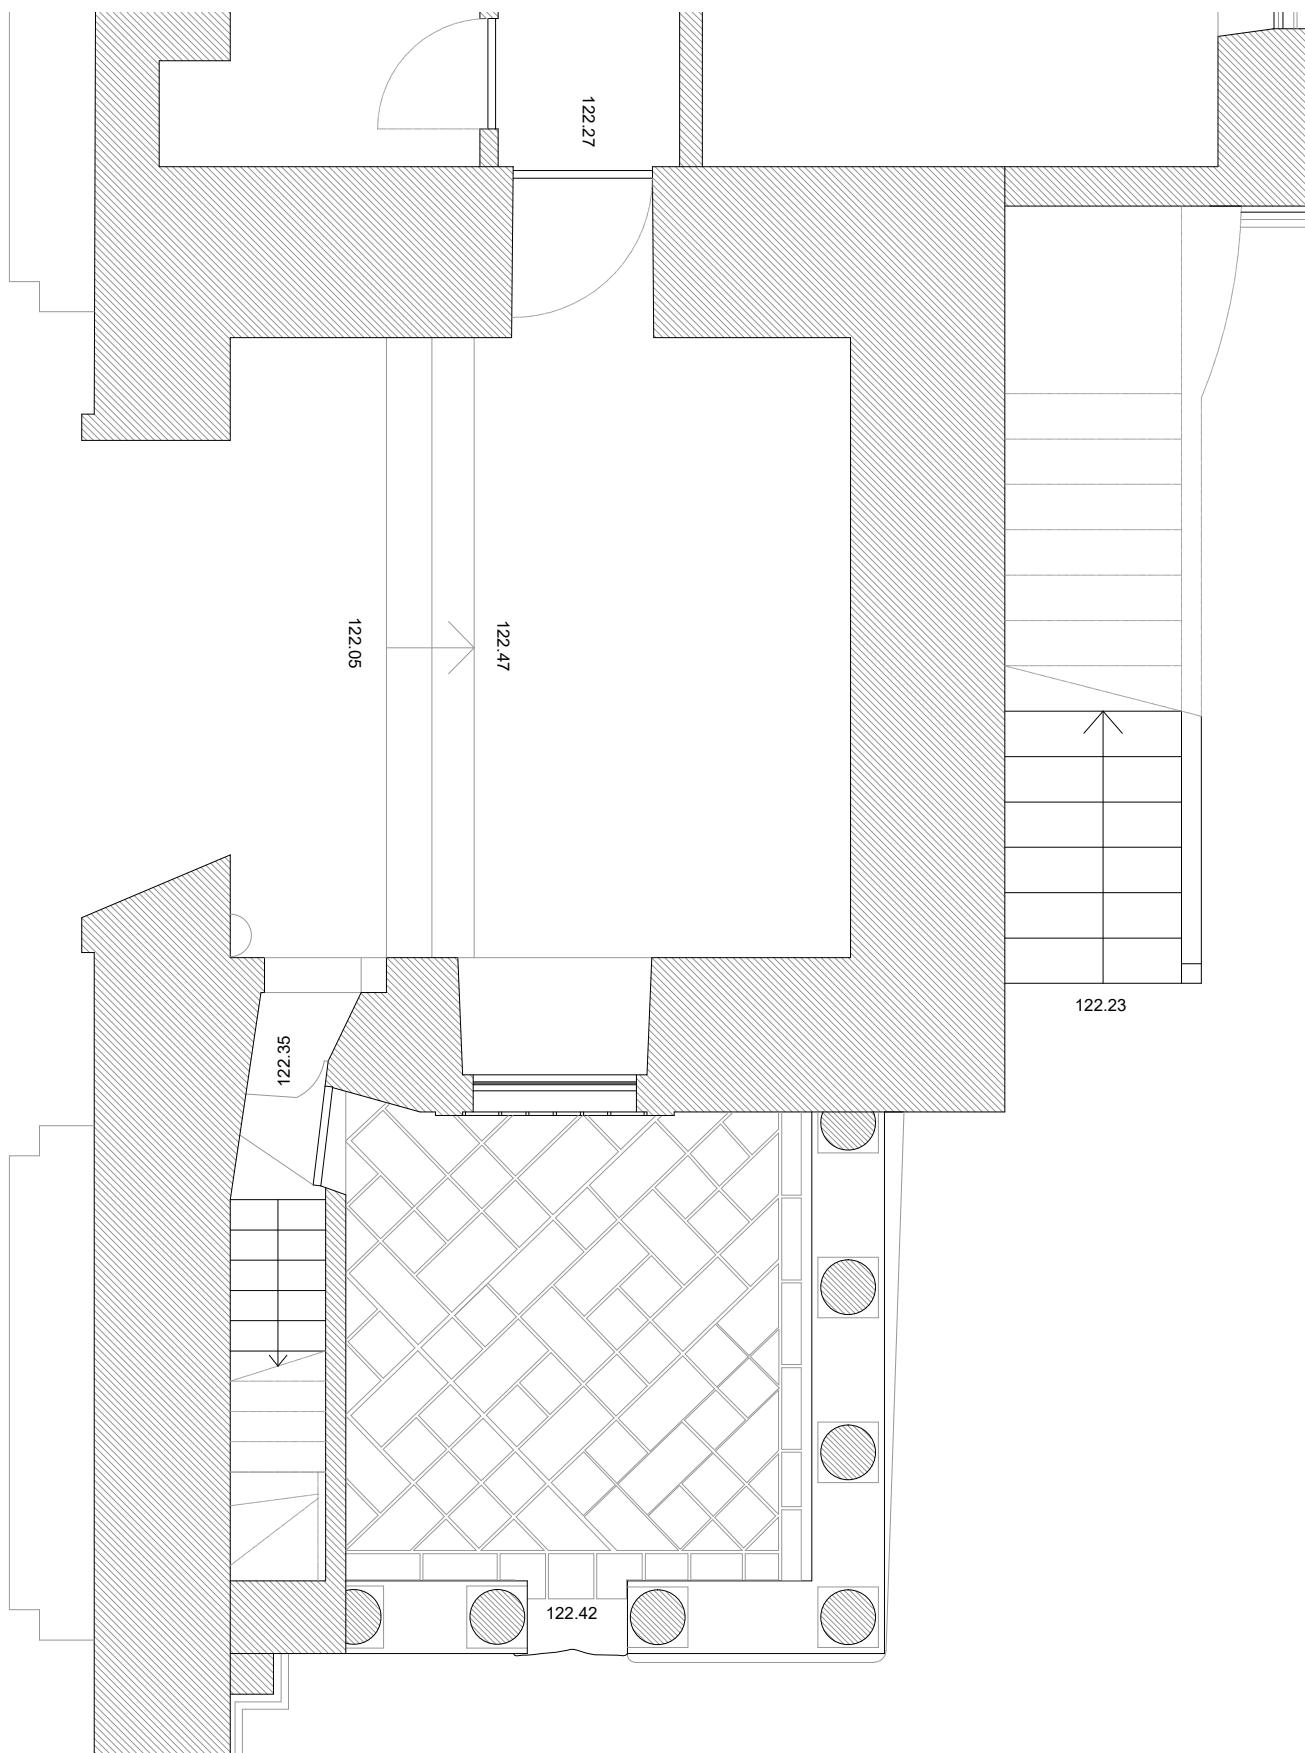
Planta primeiro piso (Loggia e Capela)
